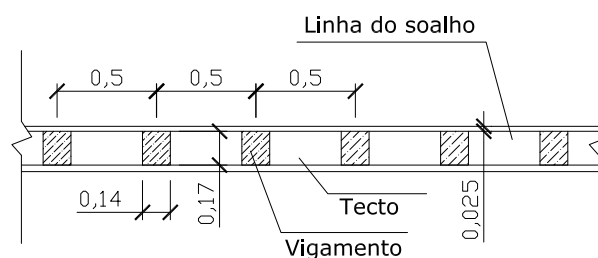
Configuração do pavimento. Pormenor construtivo do vigamento
